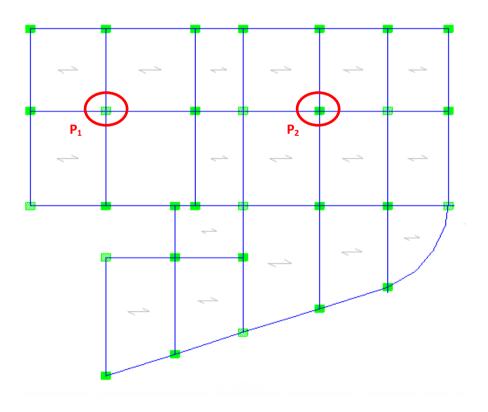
Vue en plan d'identification des poteaux de la descente de charg
